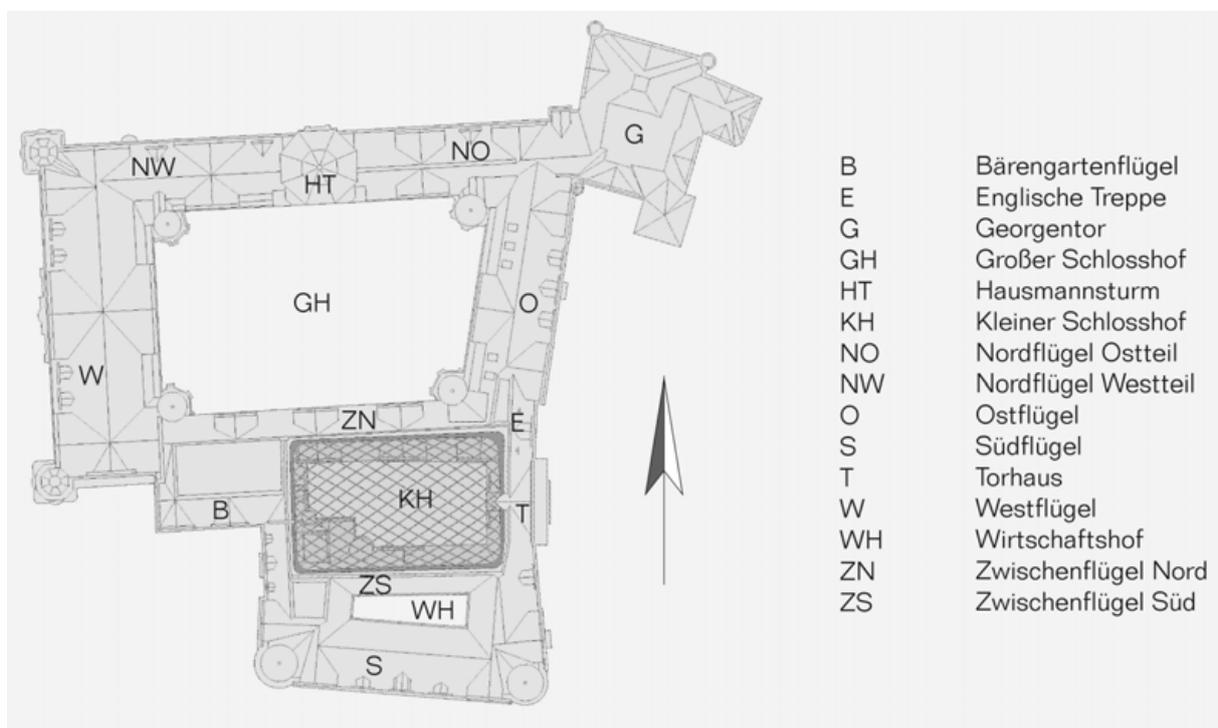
Übersicht der Gebäudeteile des Dresdner Residenzschlusses im Grundriss mit der Überdachung des Kleinen Schlosshofes
